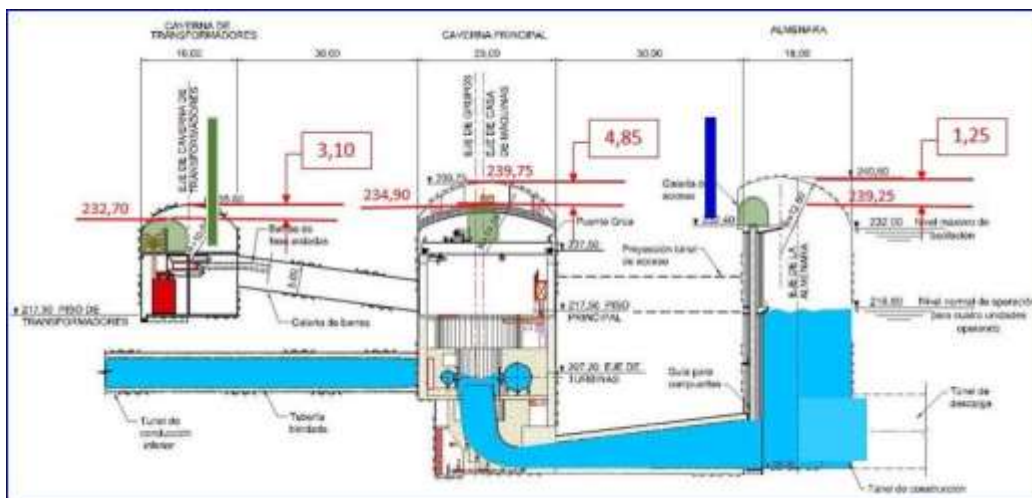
Pilar de roca de 30 m de ancho que separa la caverna de la sala de máquina y la almenara norte, que ha sido colapsada, en el lado norte, por las aguas embravecidas.
